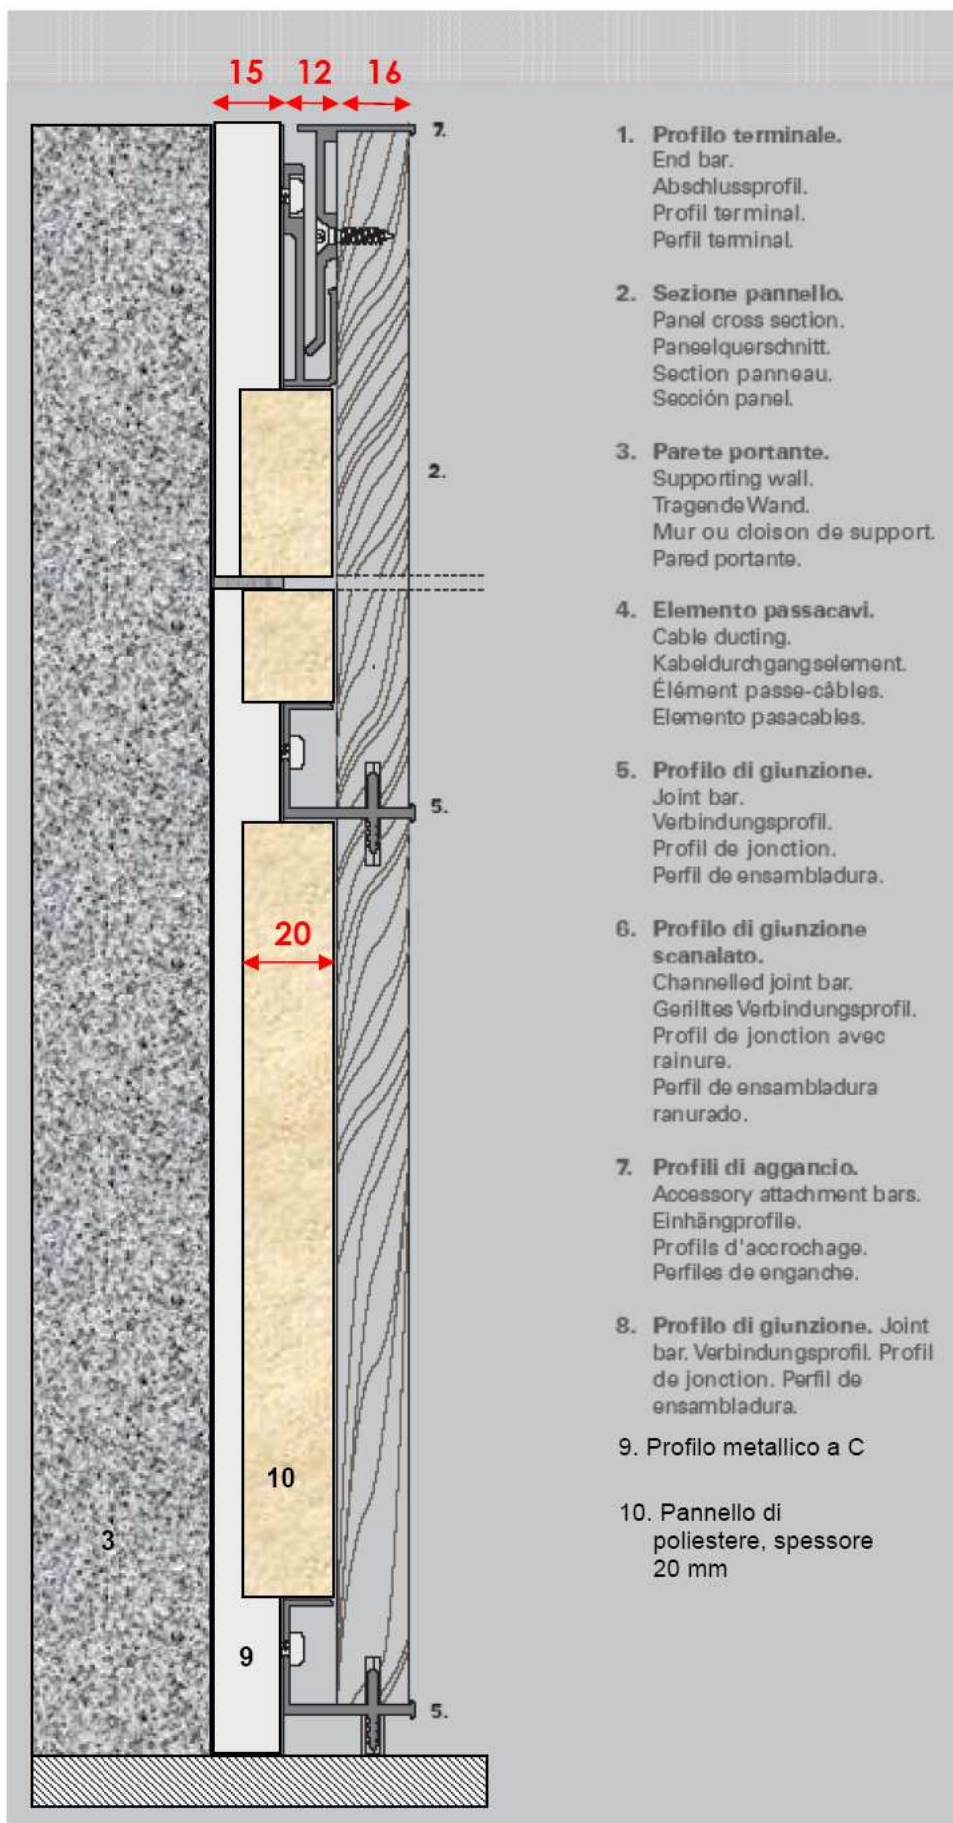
Sistema di aggancio dei pannelli fonoassorbenti tipo Patt STILLWALL 12/5 alla parete
